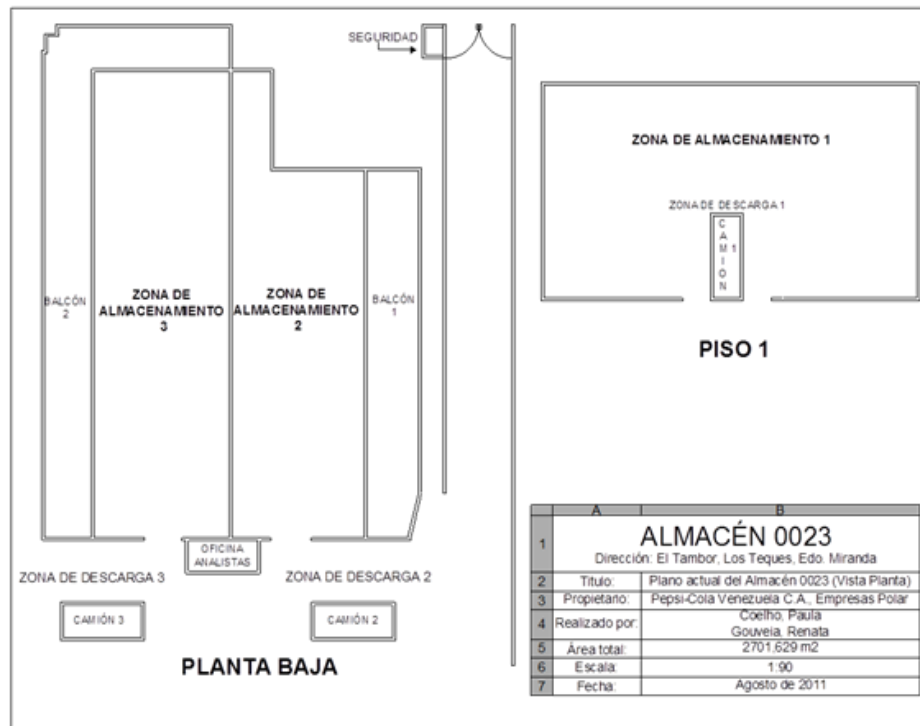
Plano del Almacén 0023 (vista planta)
